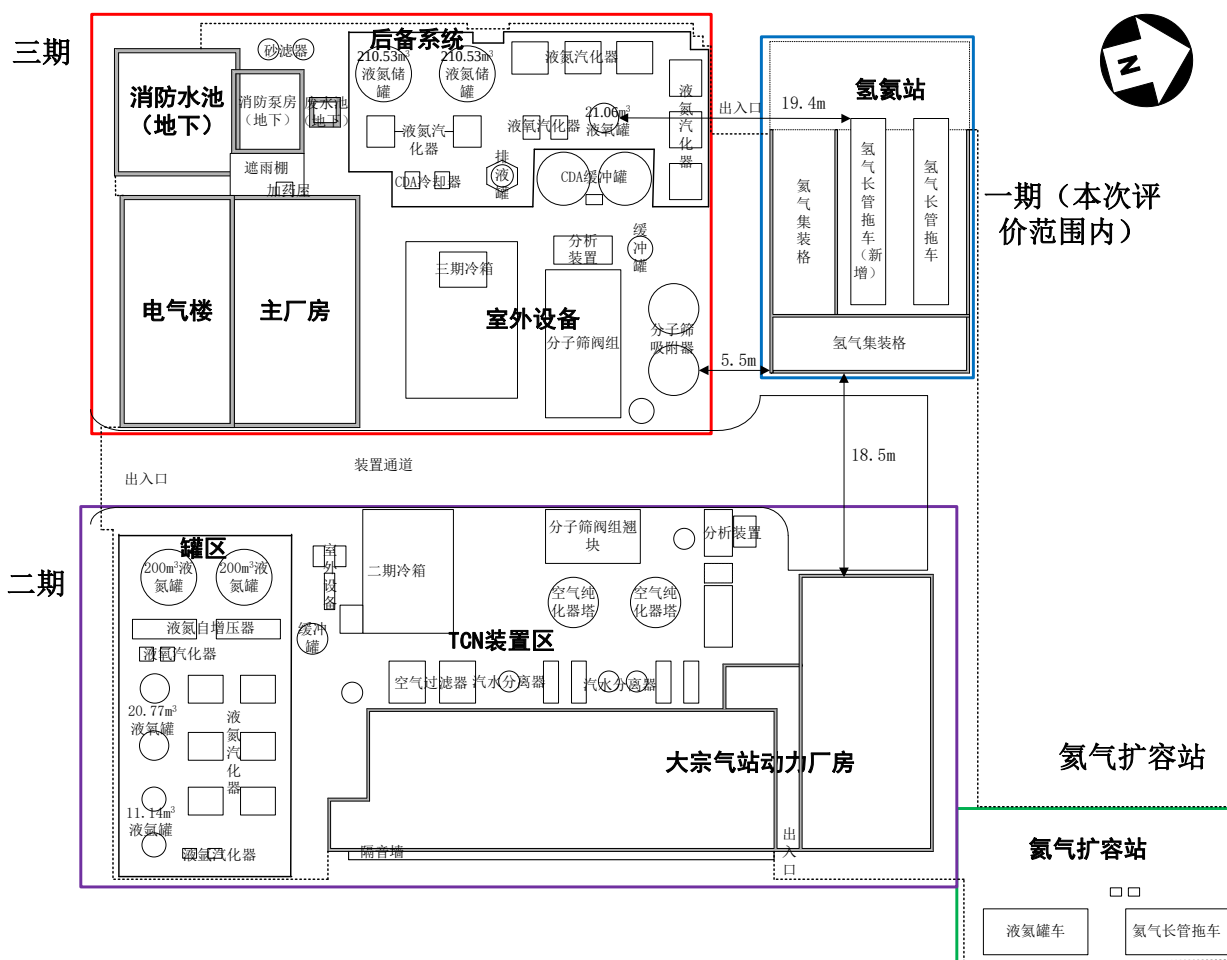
该项目厂内总平面布置示意图（氢气扩容后）
